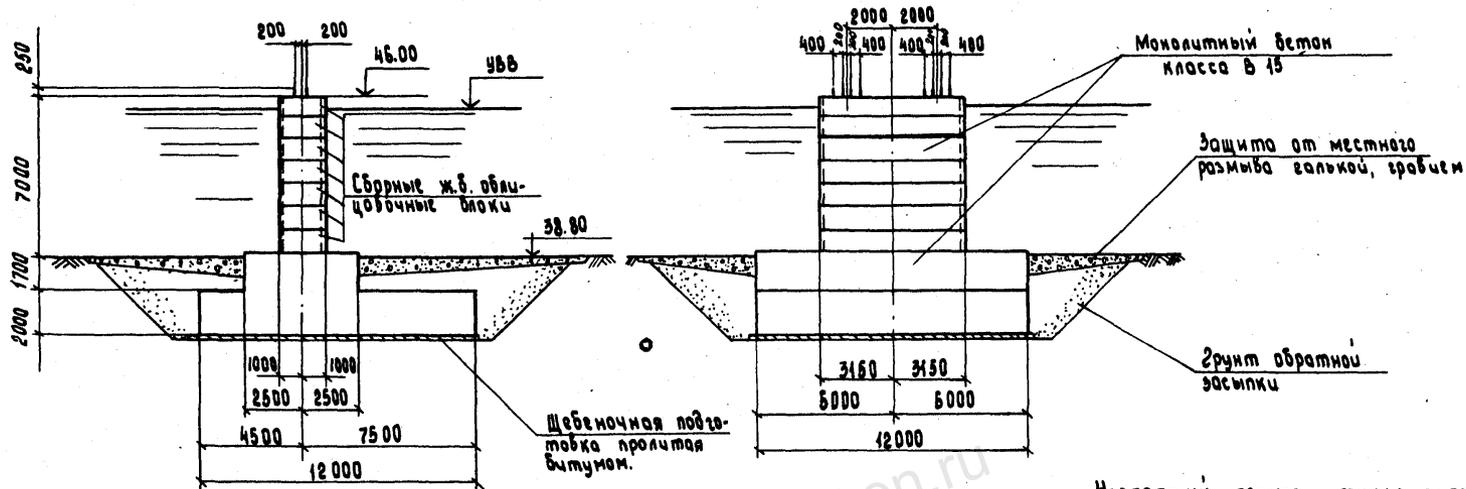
Спаренные фундаменты под две ноги опоры. Вариант фундамента со сборными плитами в основании
